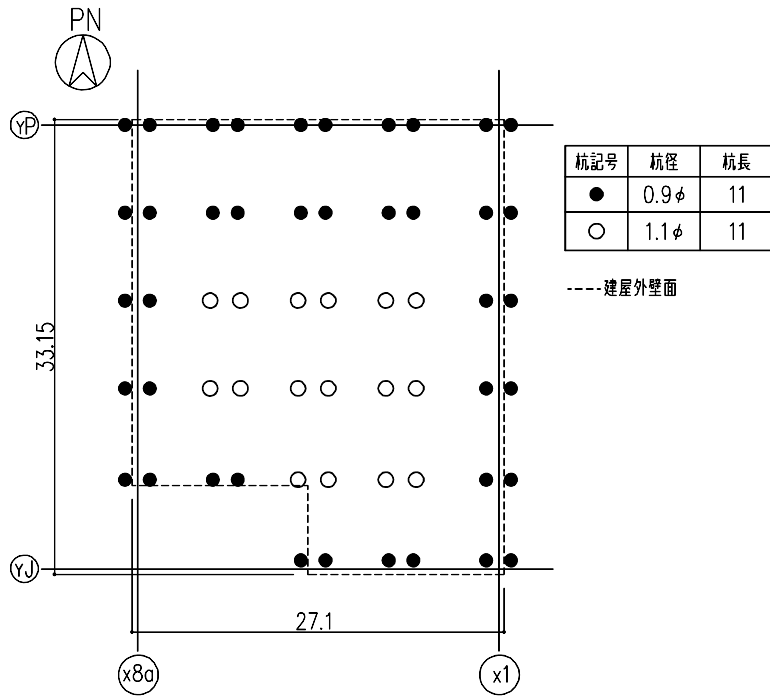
杭配置図 (G.L. -11.0) (単位 : m)
